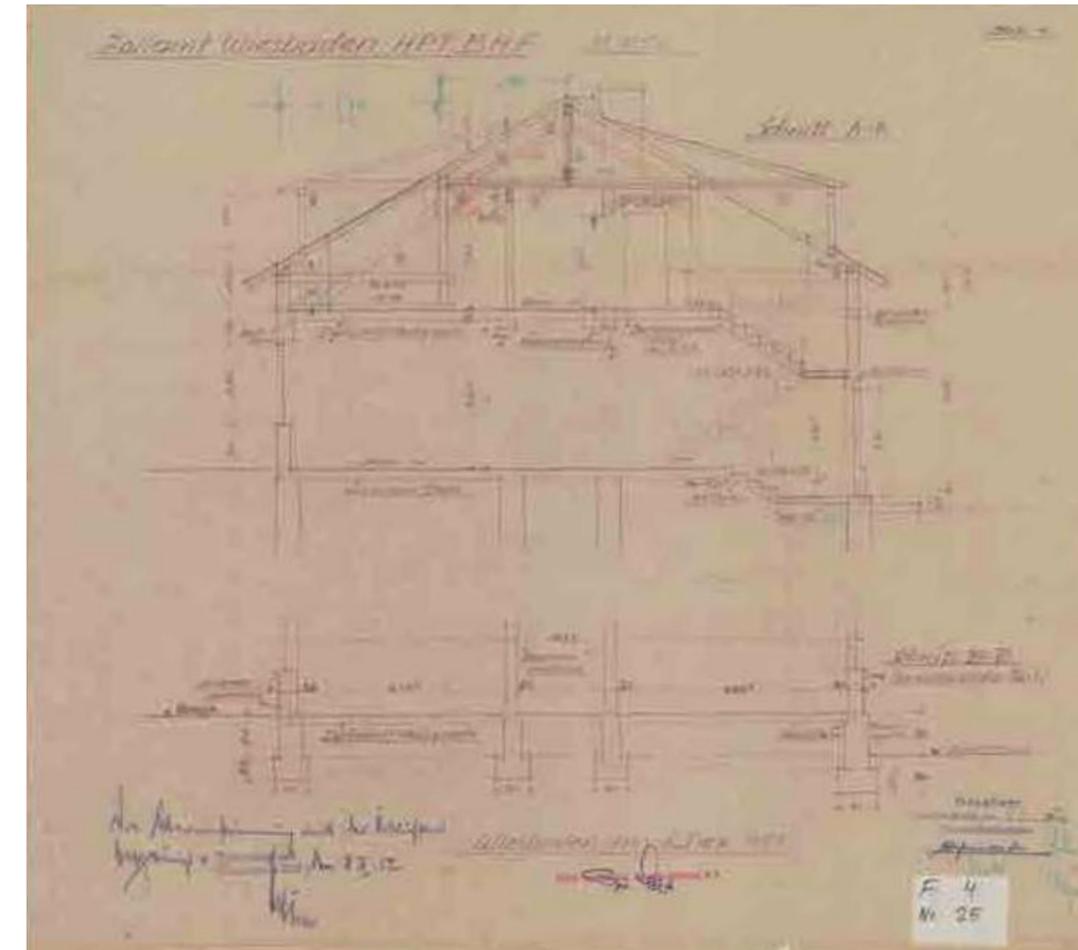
Zollabfertigung: Plan mit Querschnitt A-A und B-B für den Wiederaufbau, 1951
